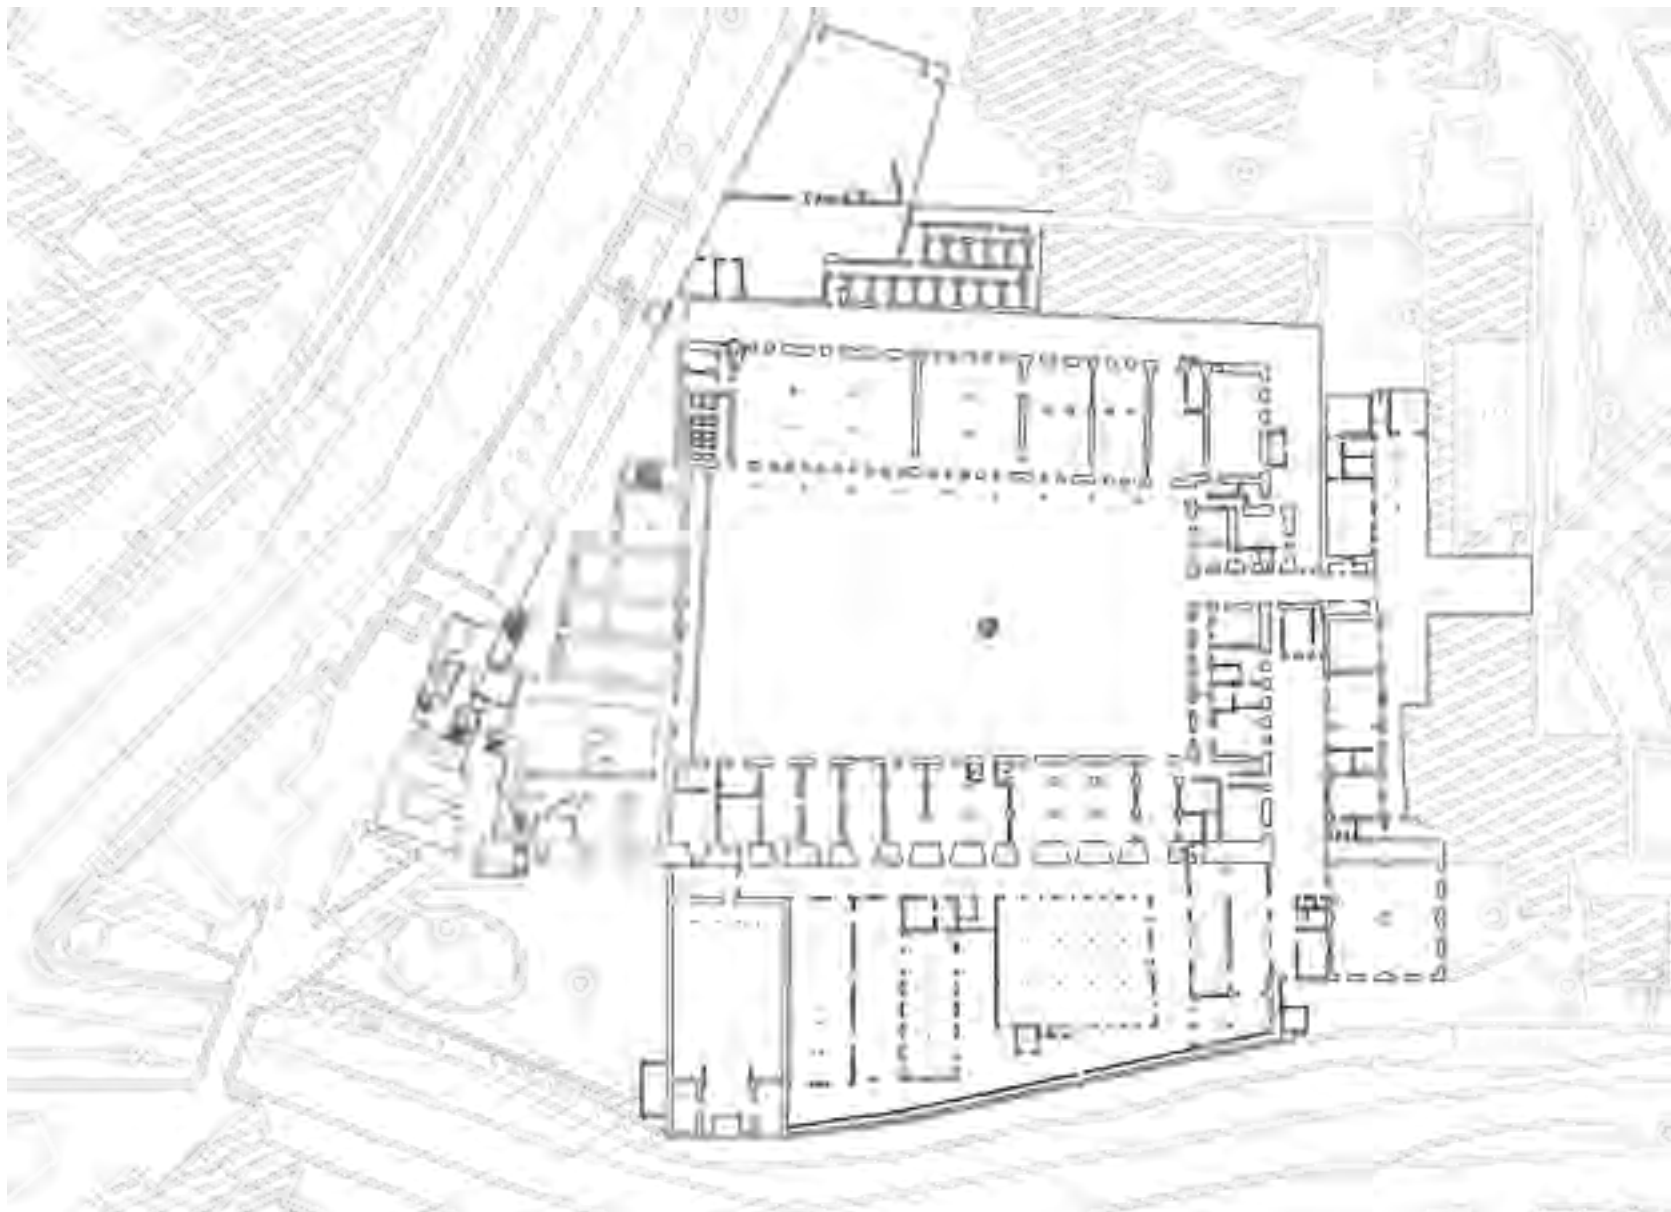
Planimetria attuale del castello carrarese, piano terra.
